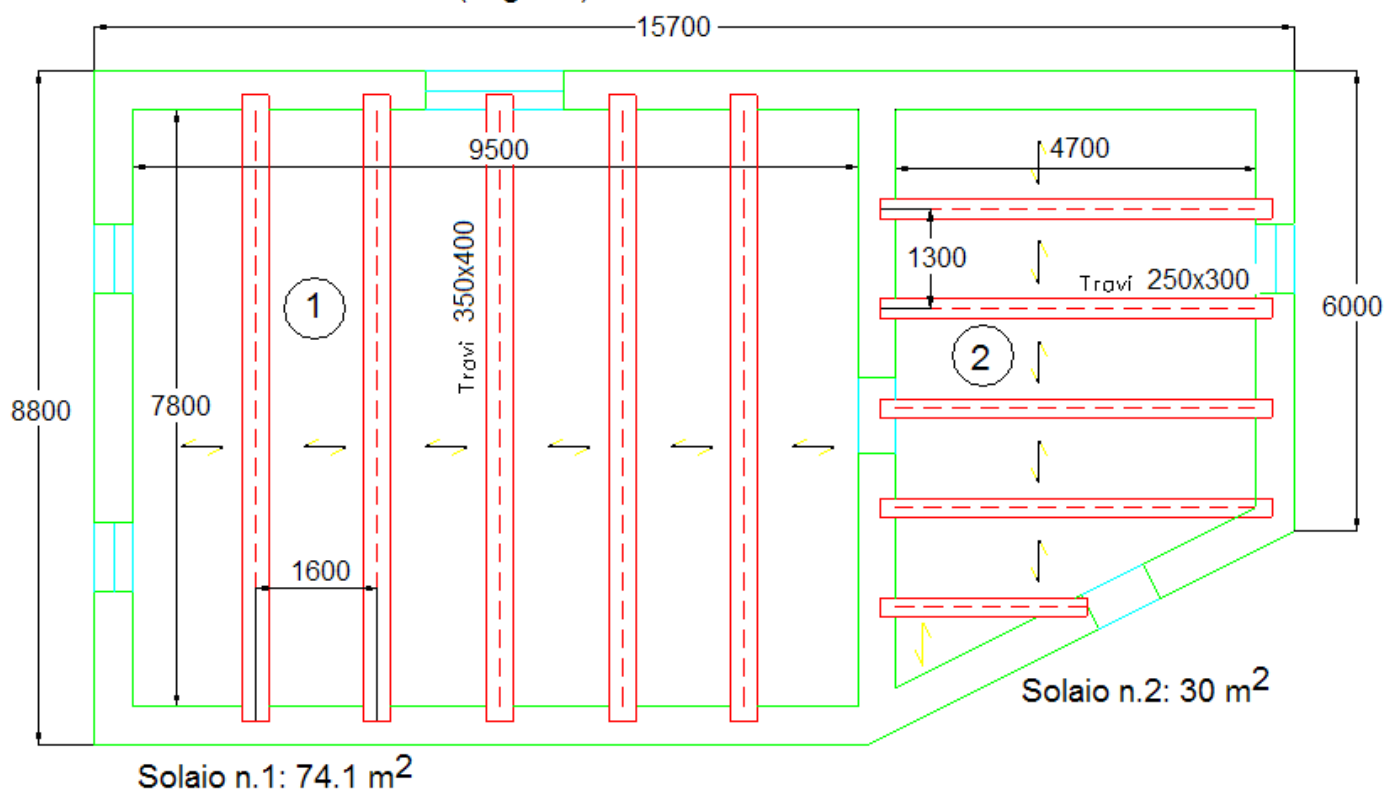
Pianta dell'edificio oggetto di intervento
